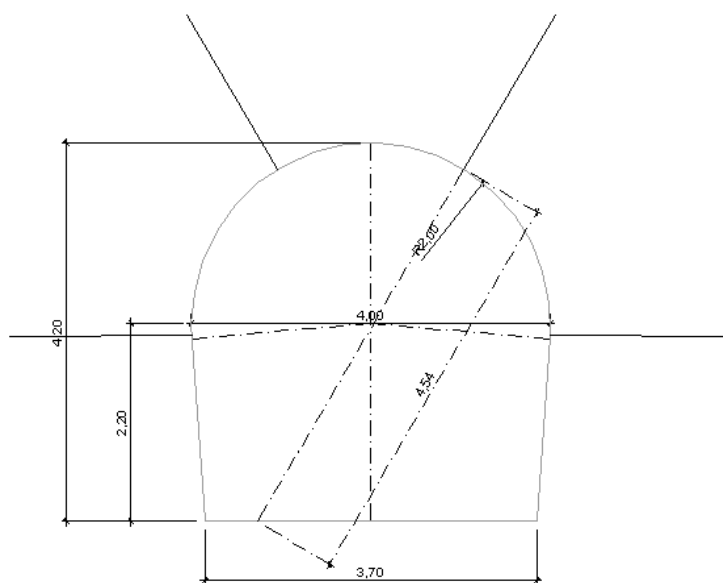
Geometria da galeria de ventilação com posição das pregagens em secção tipo B [21]
